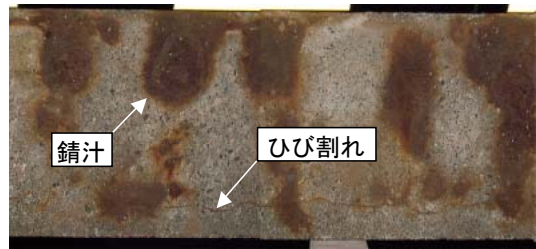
ひび割れと錆汁の状況 (梁 FB 裏面)
